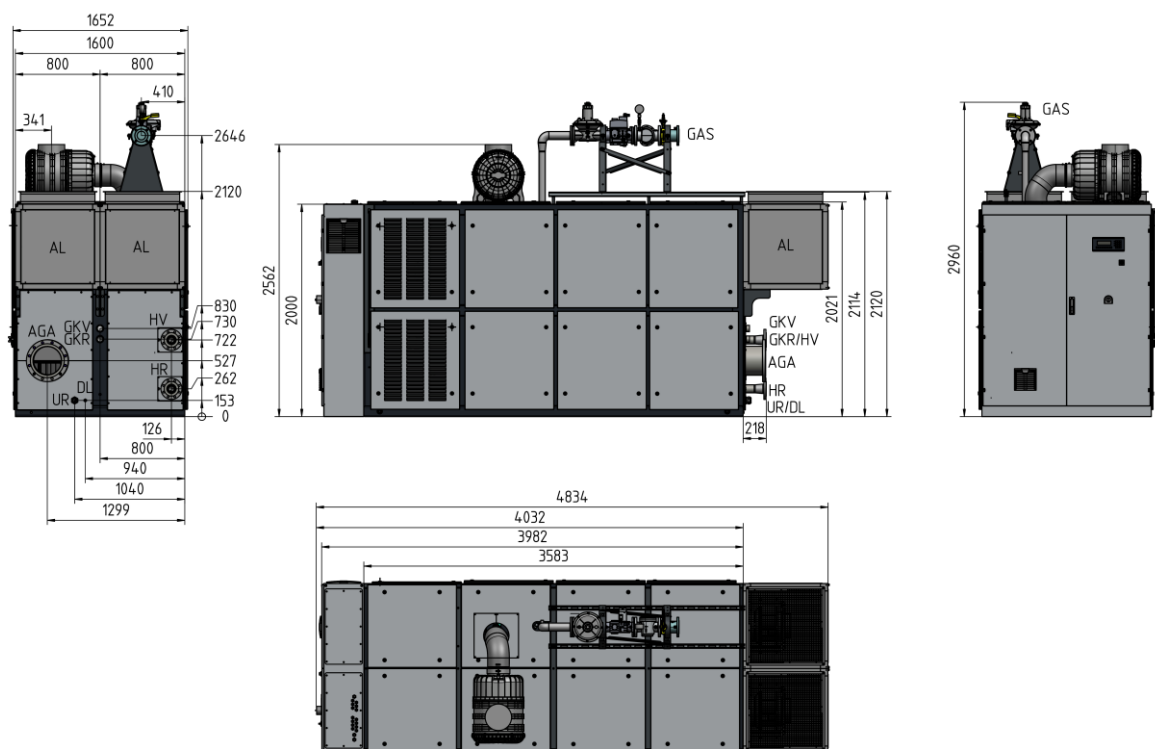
Abmessungen und Anschlüsse der BHKW Module Vitobloc 200 EM-430 SCR mit optionaler Schalldämmhaube (Maße in mm); Die bereits montierte Lüfterbox an der Rückseite kann für das Einbringen des Moduls demontiert werden.
